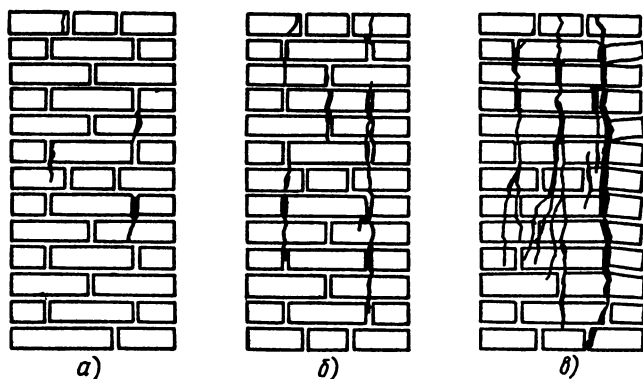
Стадии разрушения кладки под нагрузкой:
